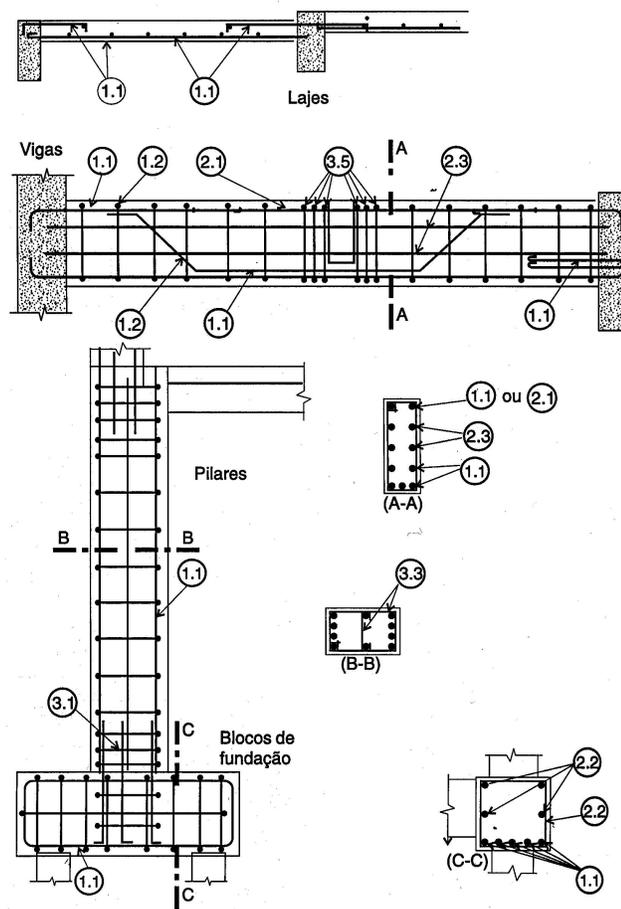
Tipos de armaduras segundo classificação (vide Tabela 3.7) proposta por FUSCO (1995)
